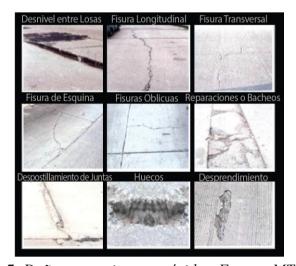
Daños en pavimentos rígidos. Fuente: MTC (2014)
